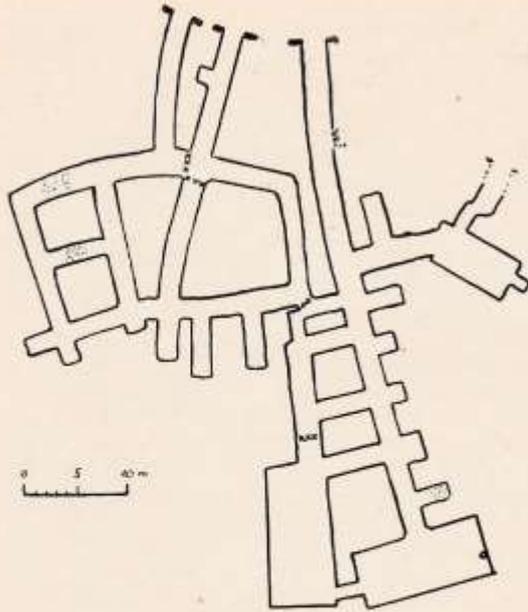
Bergkeller Theaterstraße, Grundriss.
